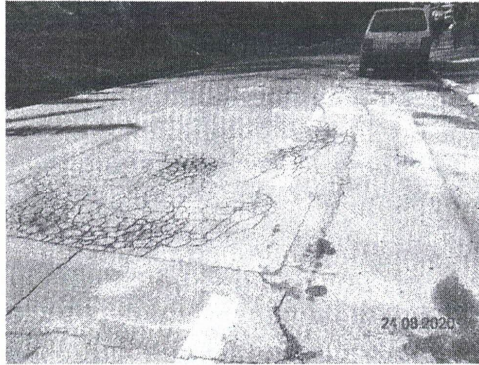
Remendo: panela preenchida com uma ou mais camadas de pavimento na operação denominada “Tapa Buraco”
